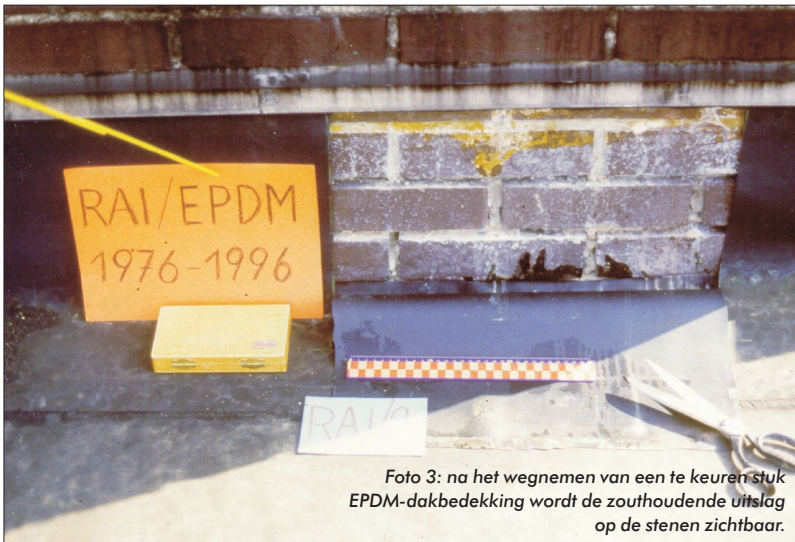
na het wegnemen van een te keuren stuk EPDM-dakbedekking wordt de zouthoudende uitslag op de stenen zichtbaar.
